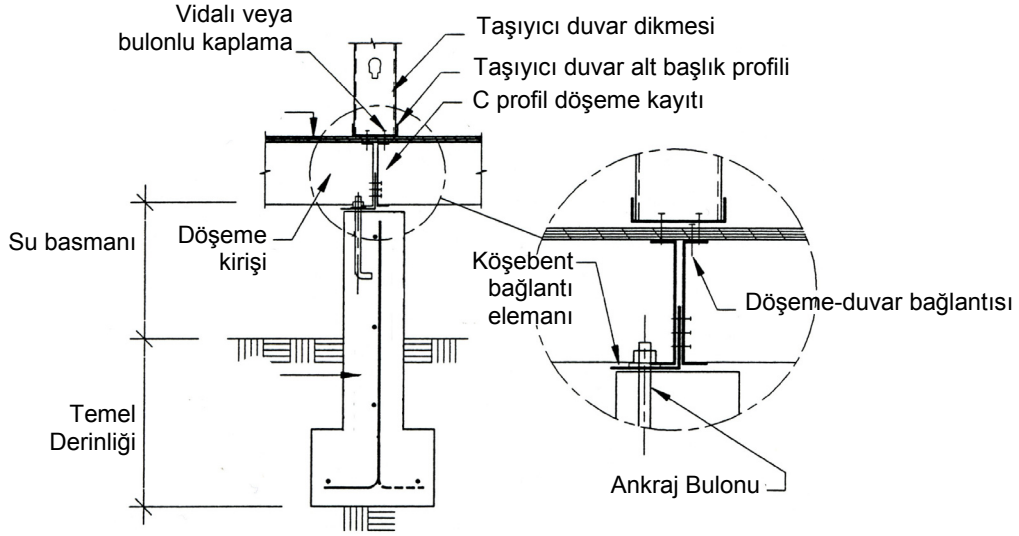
Hafif çelik sistemlerde betonarme temel ve zemin kat tabliyesi [36]
